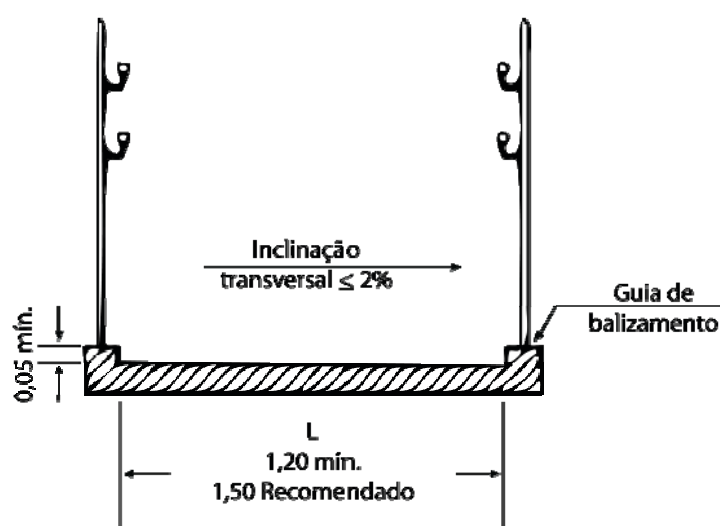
Inclinação transversal e largura de rampas – Exemplo.
